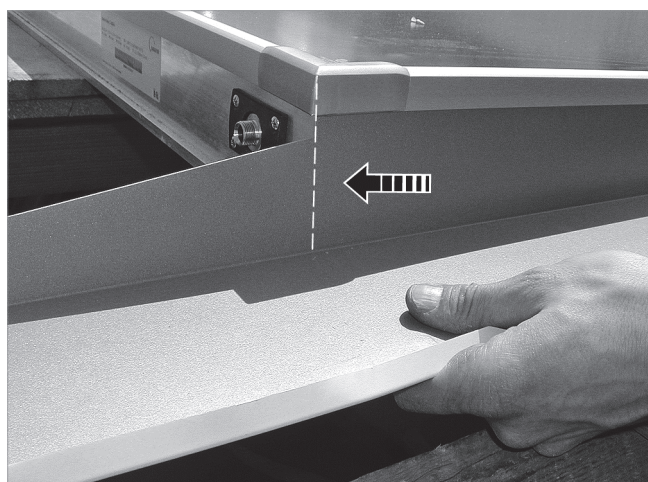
pousser la partie supérieure vers le haut, contre la butée
